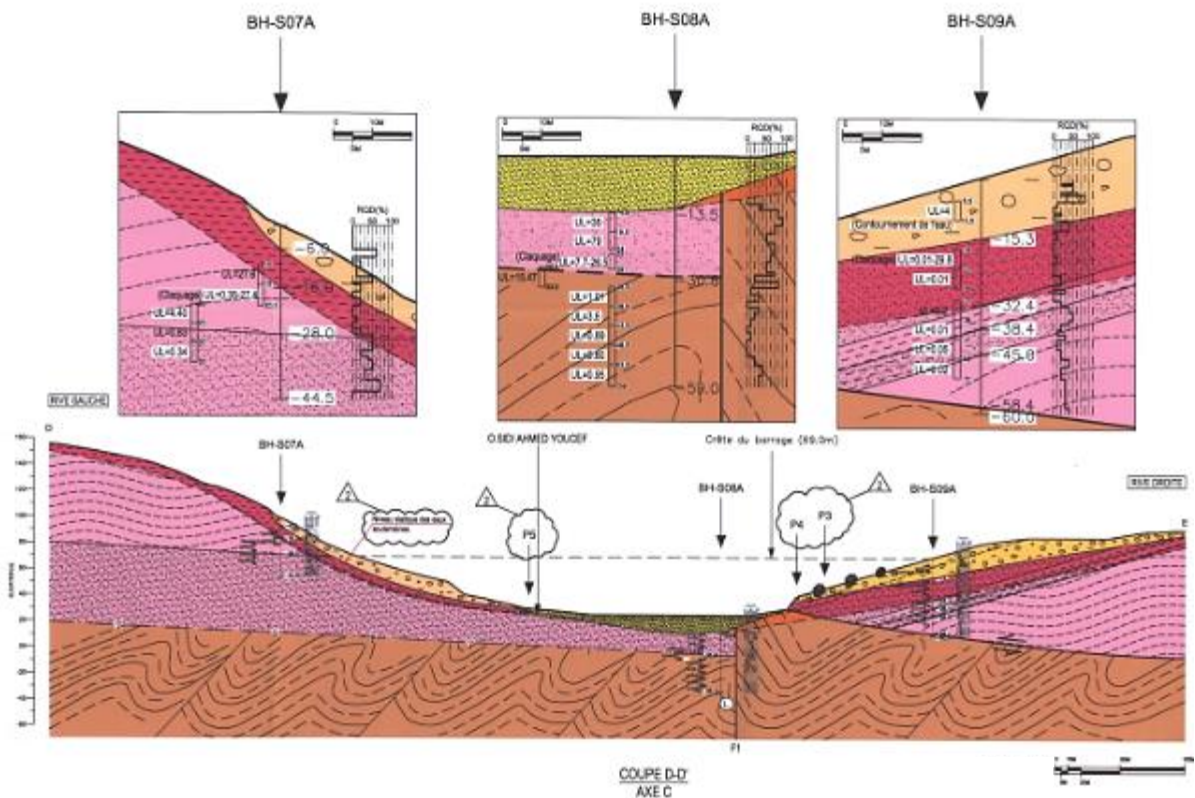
Coupe géologique du site du barrage (coupe D-D')
